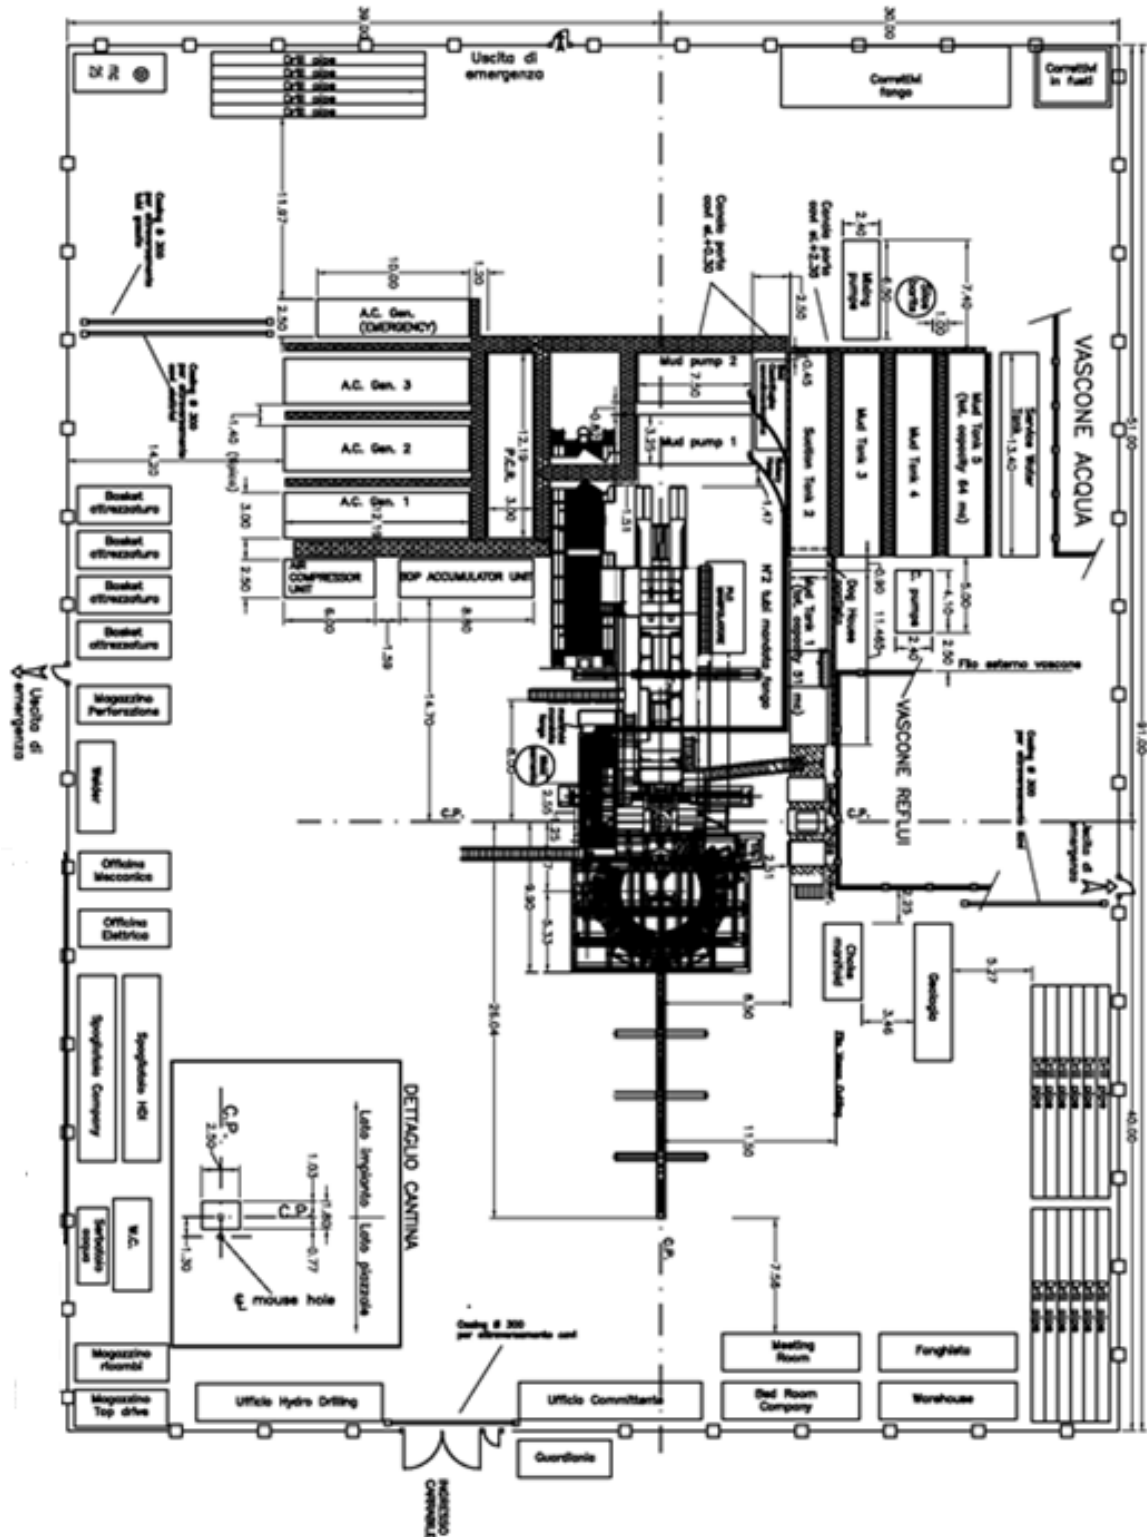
b – Planimetria opere civili della postazione dell'impianto di perforazione HH220
